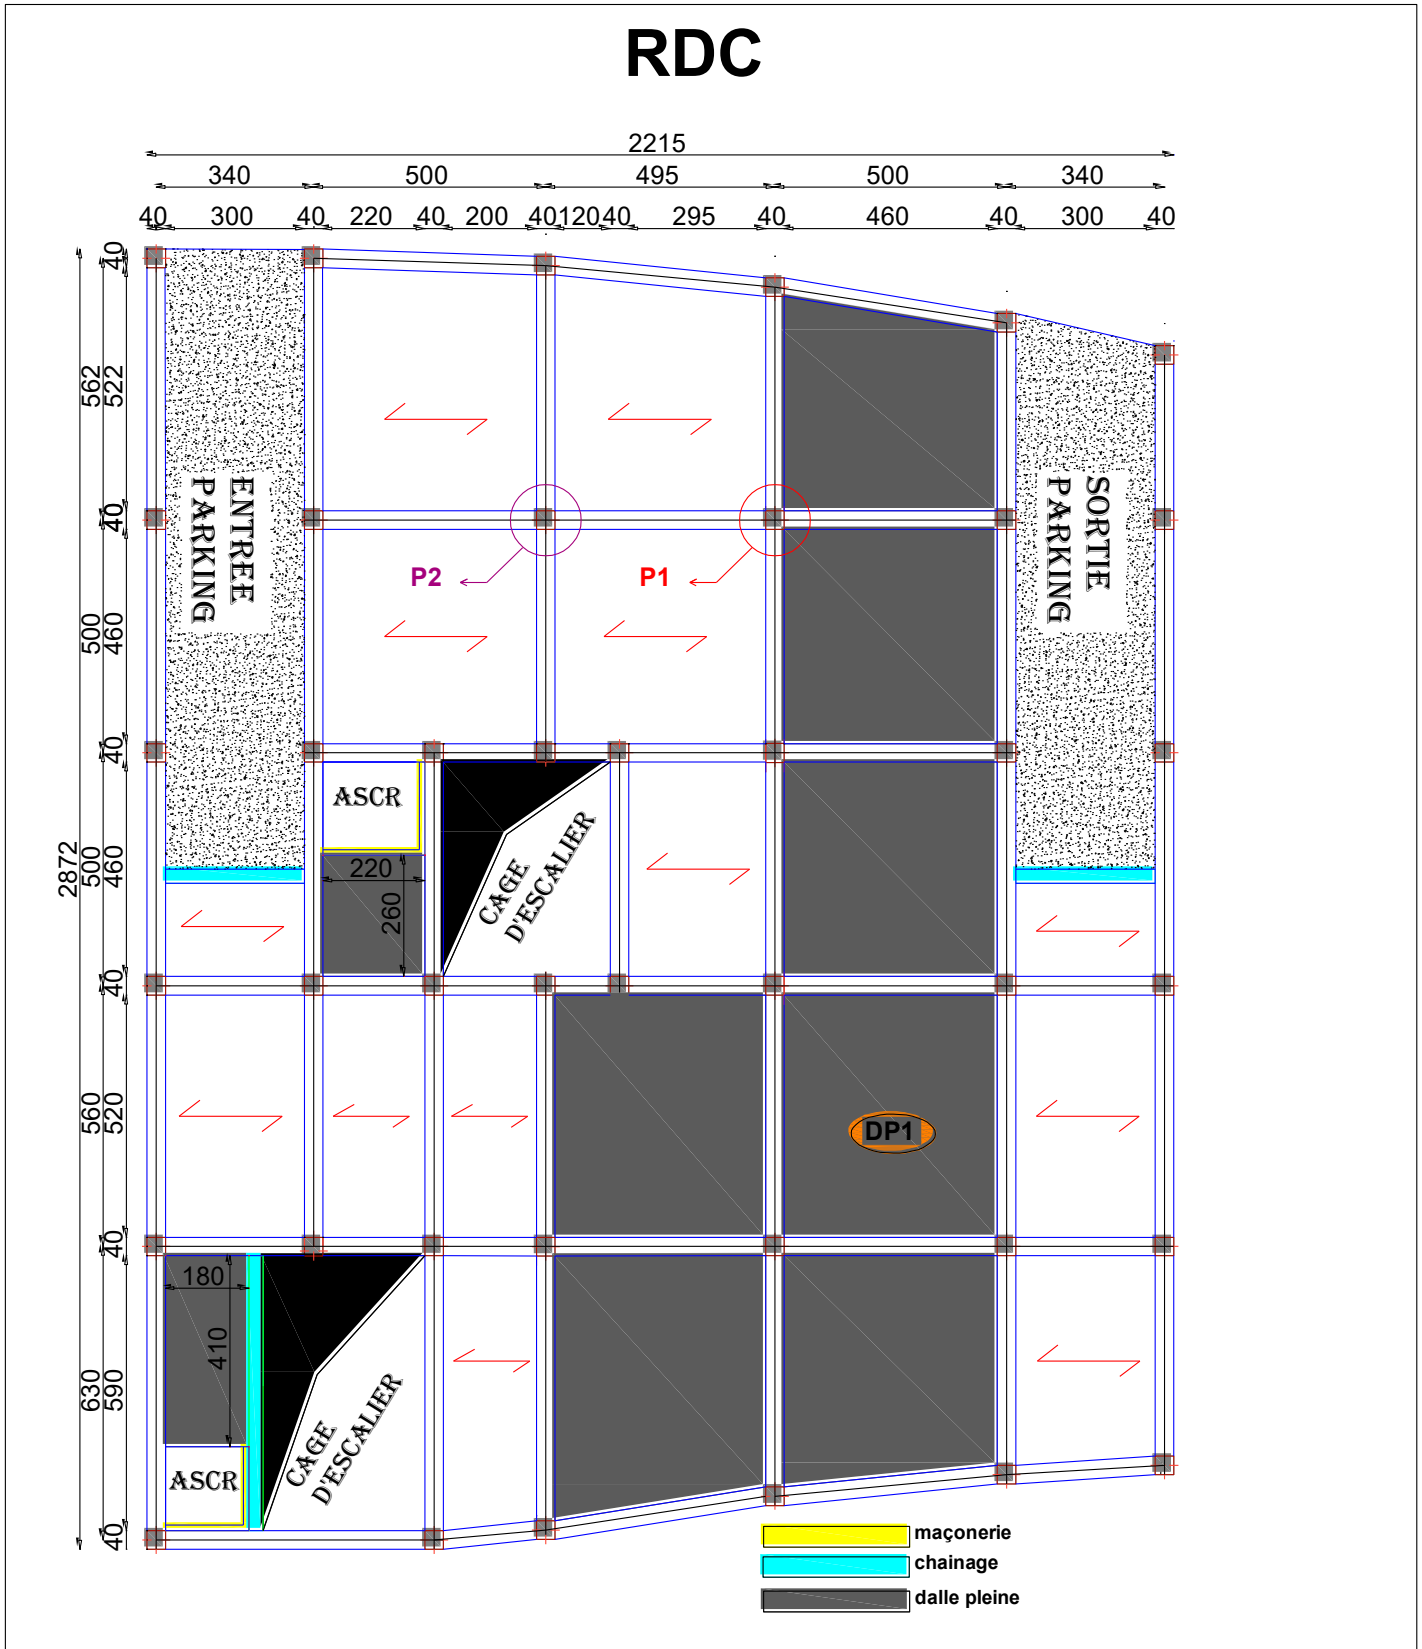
Plan de disposition des poutrelles et emplacement des dalles pleines RDC.
